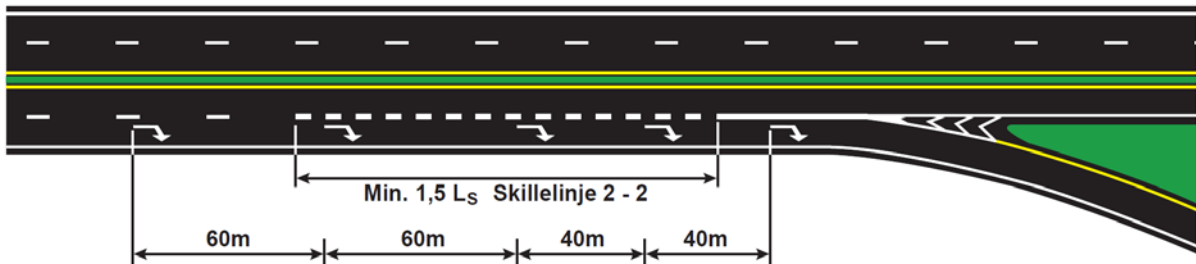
Planskilte kryss – langsgående oppmerking på primærveg
